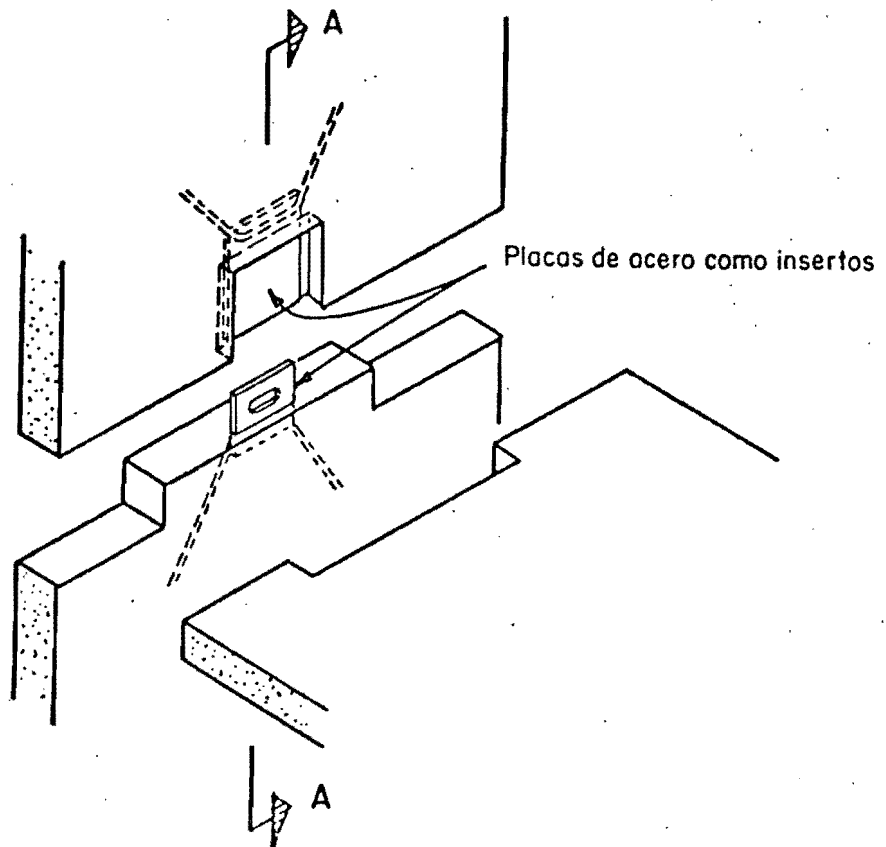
Conexiones soldadas (ref 10)
